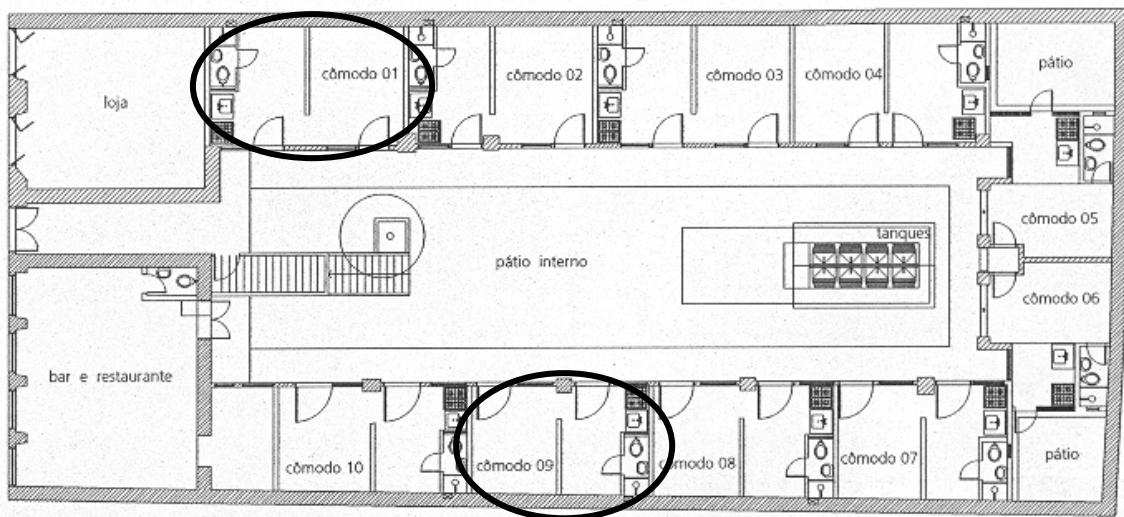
Planta baixa do primeiro pavimento, depois da intervenção. Apartamentos com instalações individuais (SECRETARIA, 2000, p. 35, respectivamente).
